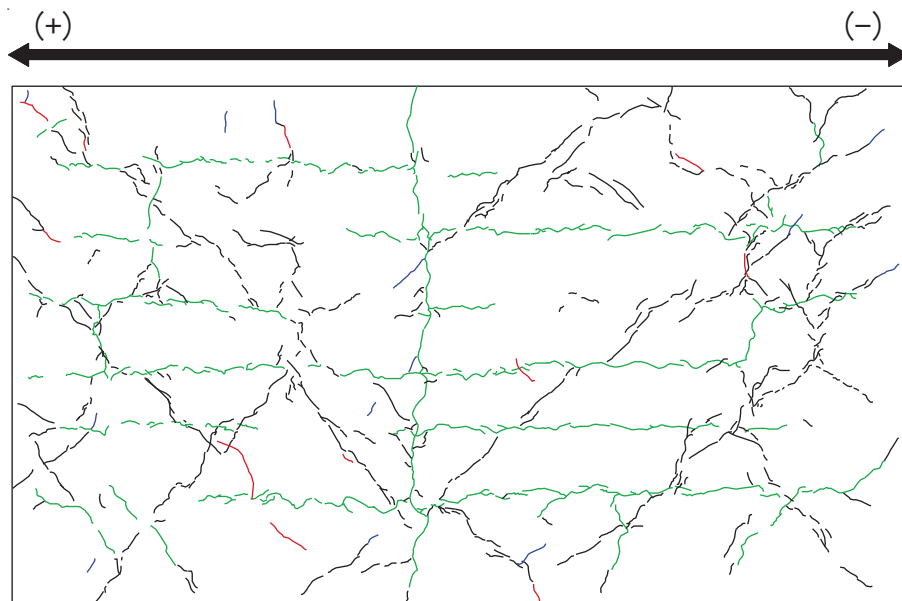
(8) 乾燥試験体 [1] 1/1000rad. におけるひび割れ図
